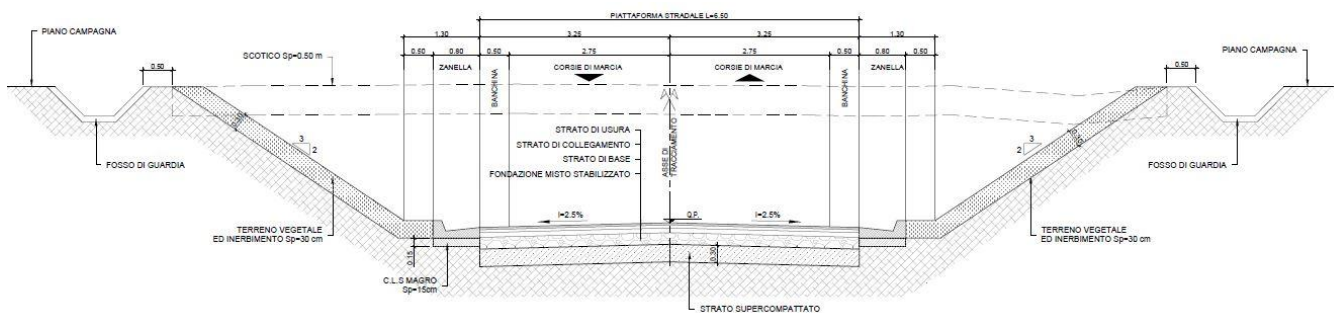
Dest. Particolare 6.5m - sezione tipo in trincea
